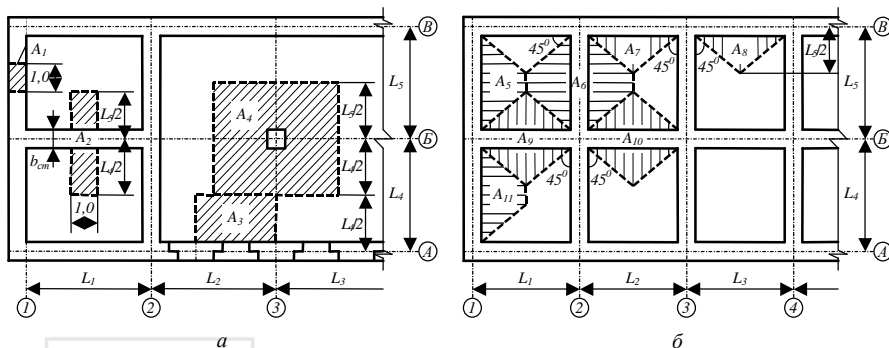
Схема підрахунку навантаження на відповідні вантажні площі, що передають навантаження на уступ фундаменту:
